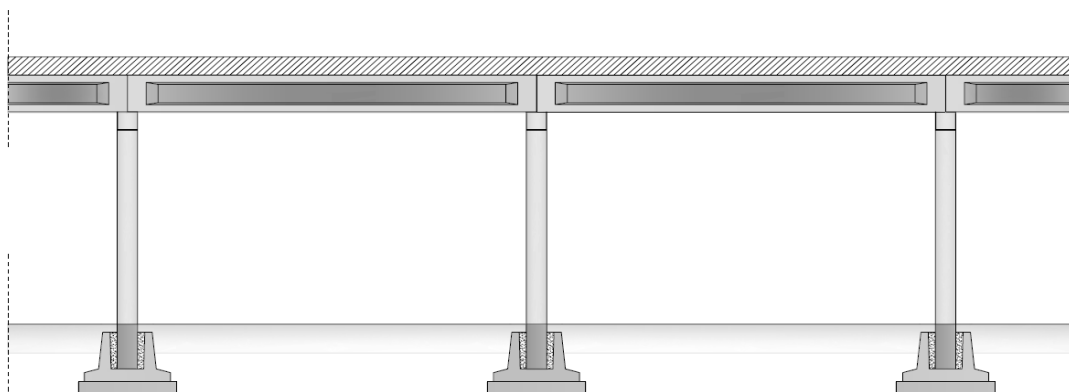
Exemplo de cobertura plana com viga plana em I [12]
